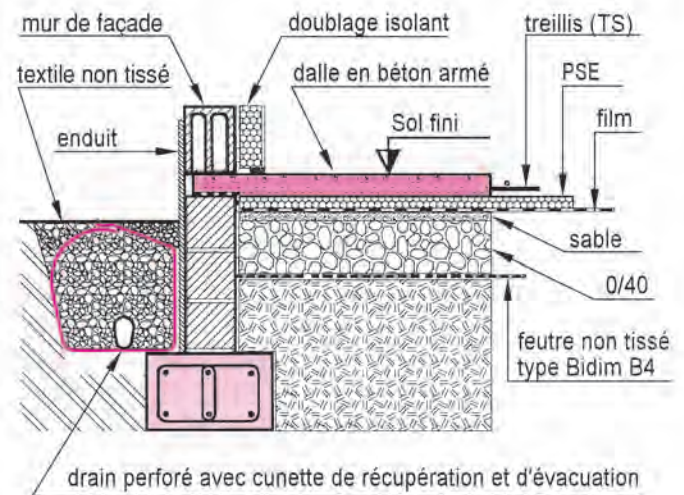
Soubassement avec drainage en pied de mur extérieur
